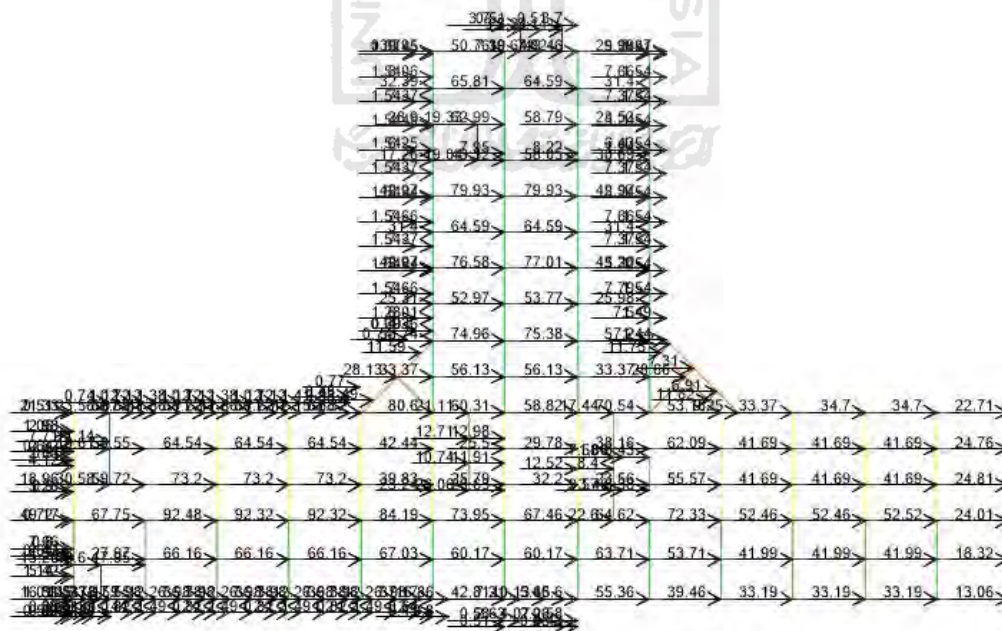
18 Gaya Joint Load Fpx Arah X pada Lantai 3
